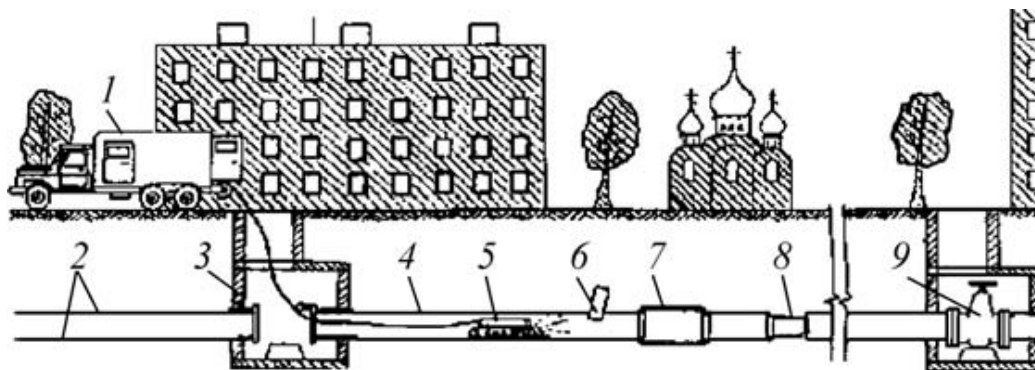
Схема обследования внутреннего состояния подземного трубопровода мобильным роботом:
